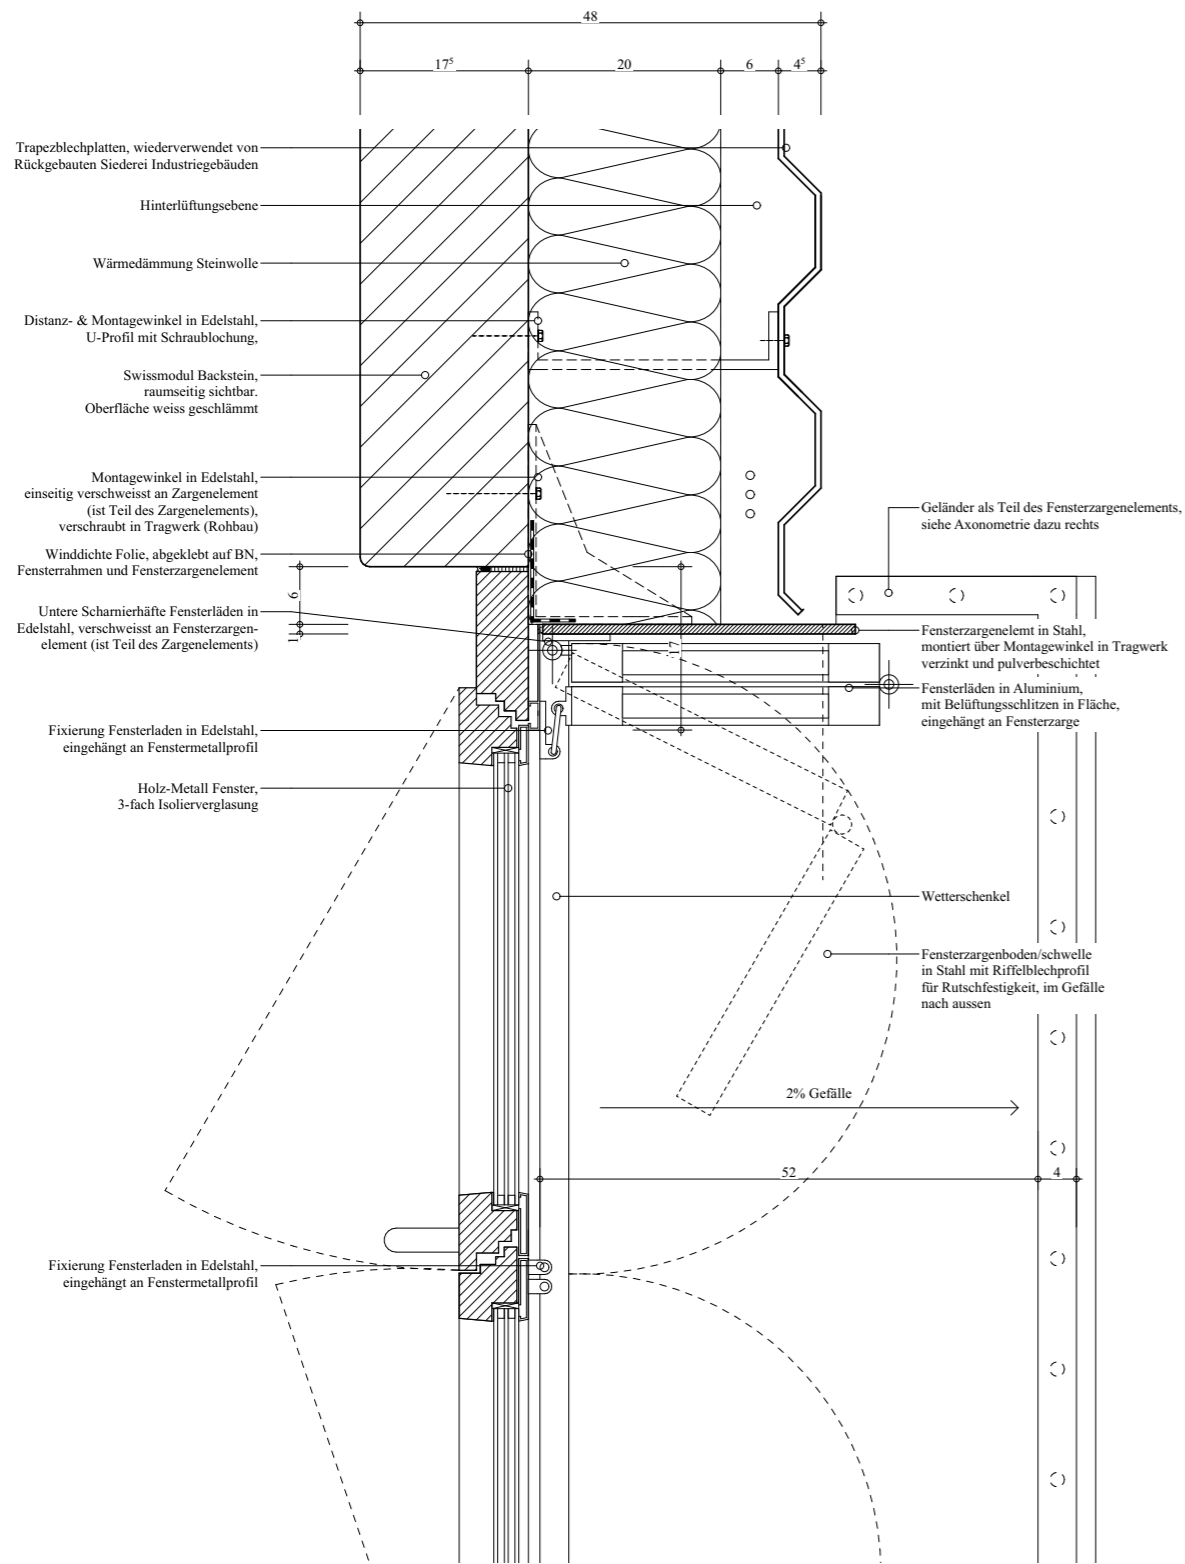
Konstruktive Vertiefung Ostfassade Neubau - Details
